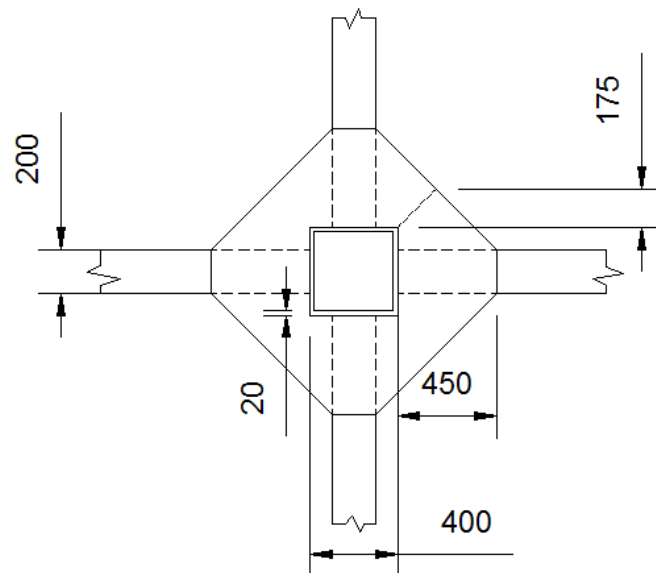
Vista en planta de la conexión viga tubular-columna tubular rectangular compuesta con diafragma externo. (Dimensiones en *mm*)
